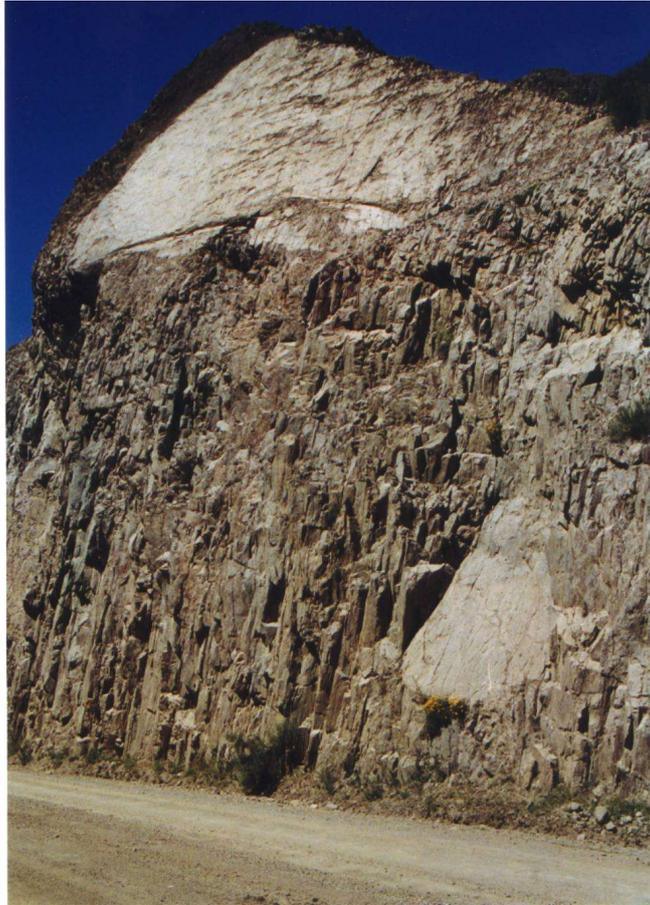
Detalle de los planos de diaclasa inclinando hacia el camino
